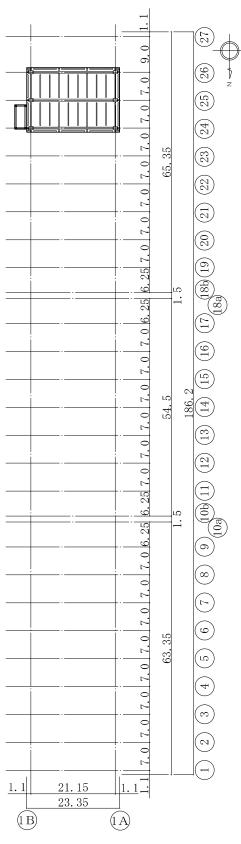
屋上階平面図 (G. L. +22. 850) (単位:m)
